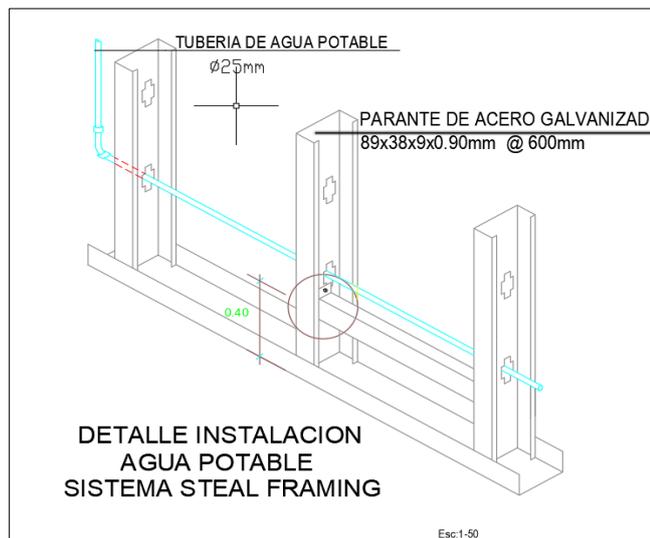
Detalle Instalación Agua Potable Sistema Drywall
